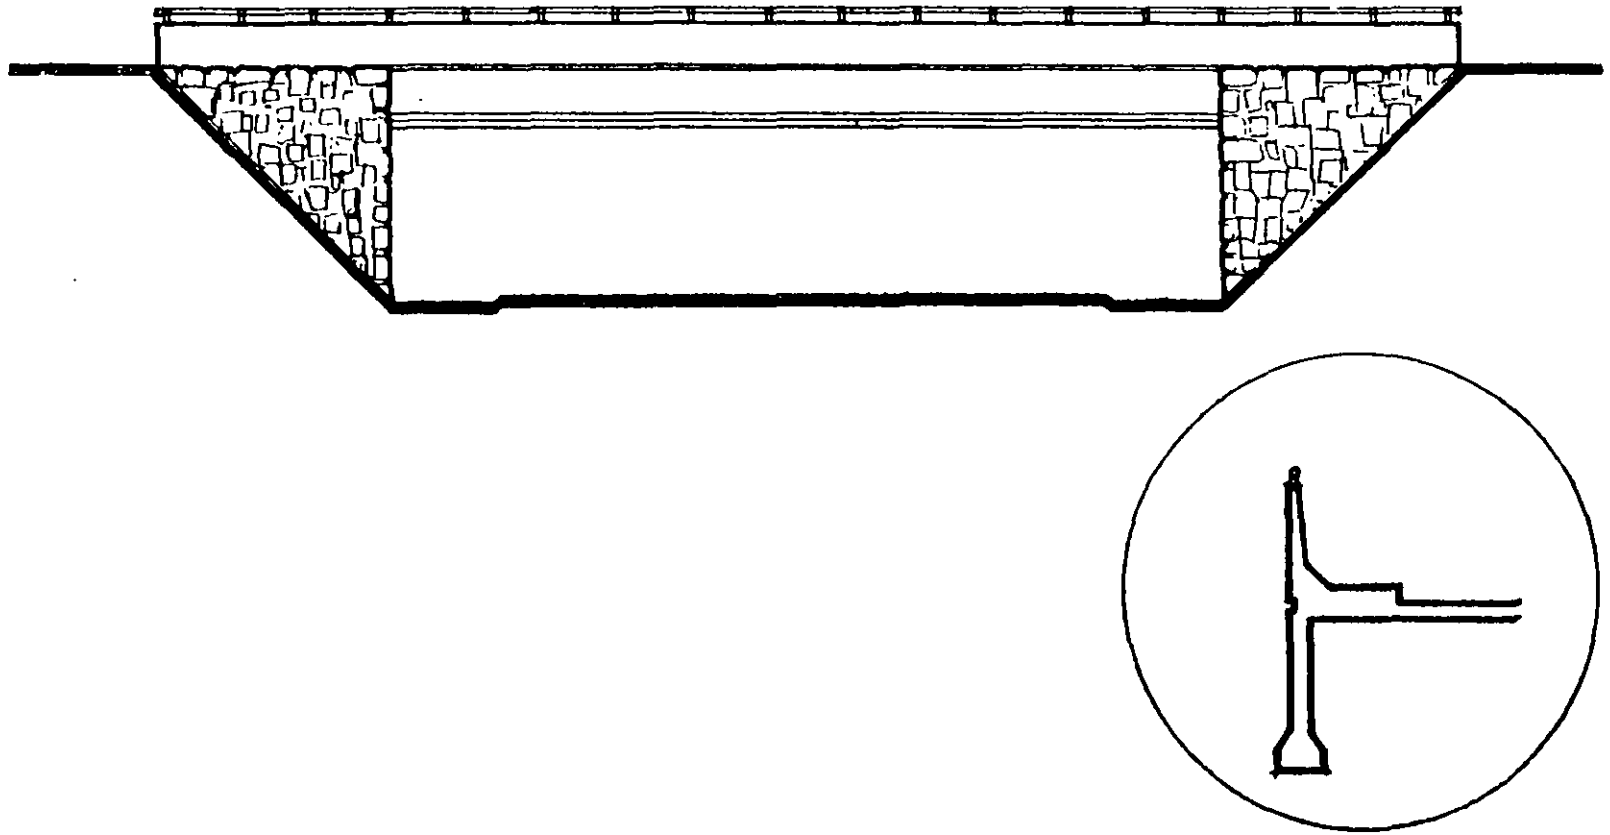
PARAPETO DE CONCRETO AL MISMO PAÑO QUE LA ESTRUCTURA, CON UNA INCISION QUE SEPARA LOS DOS ELEMENTOS
